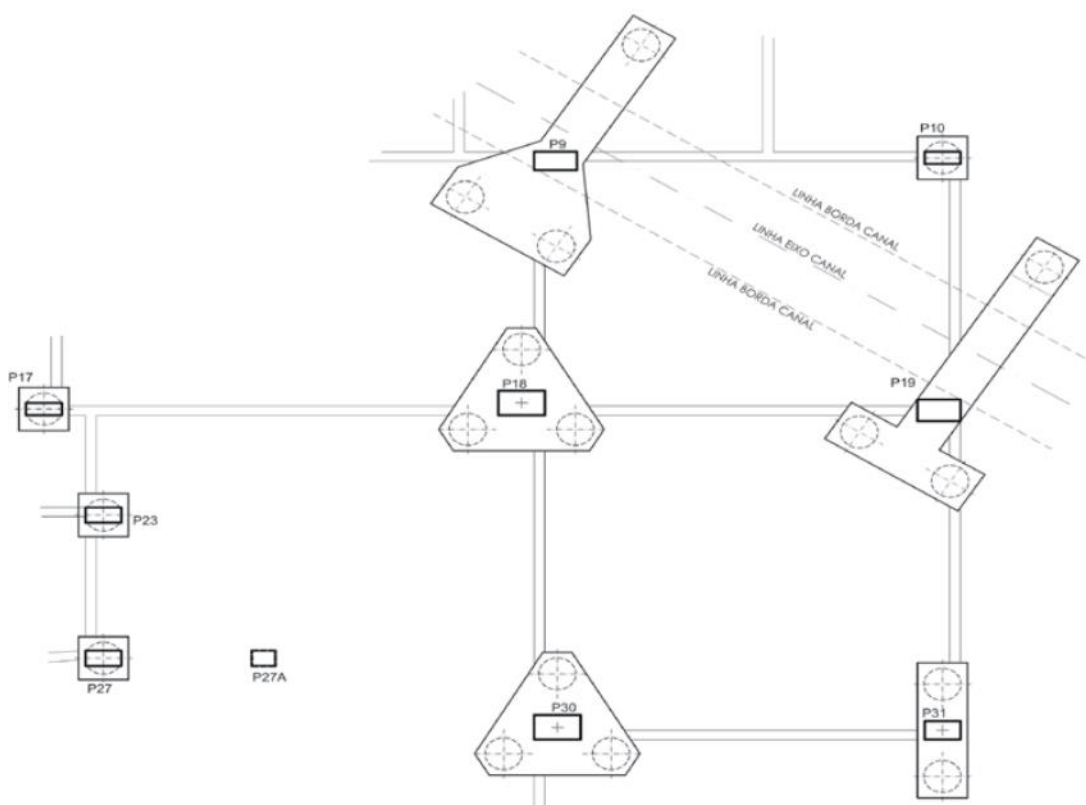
Planta de fôrma - Pilar Adicional P27A
